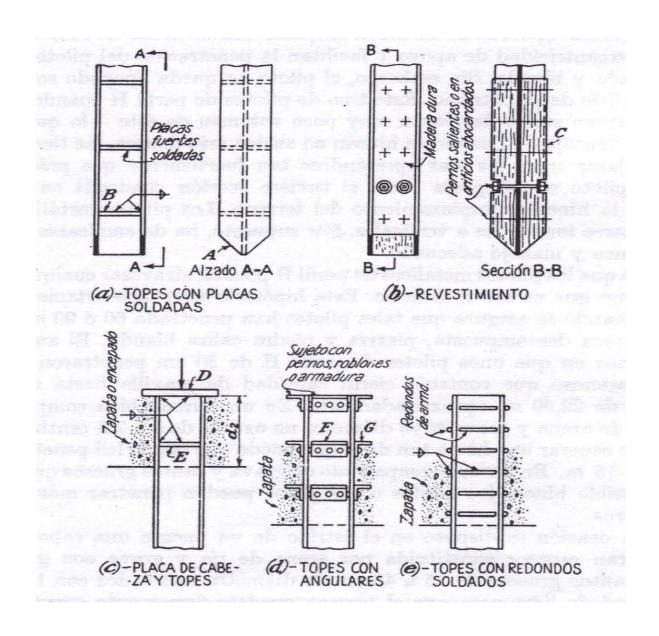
Detalles correspondientes a los pilotes metálicos de perfil H.
